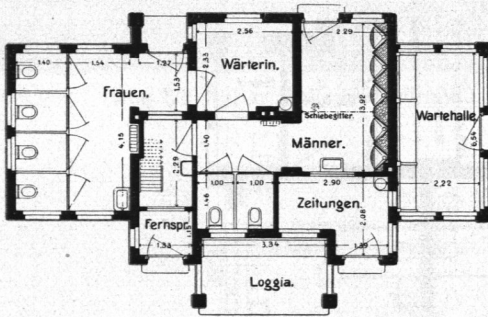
Bedürfnisanstalt mit Wartehallen Eppendorferbaum, Grundriß.
